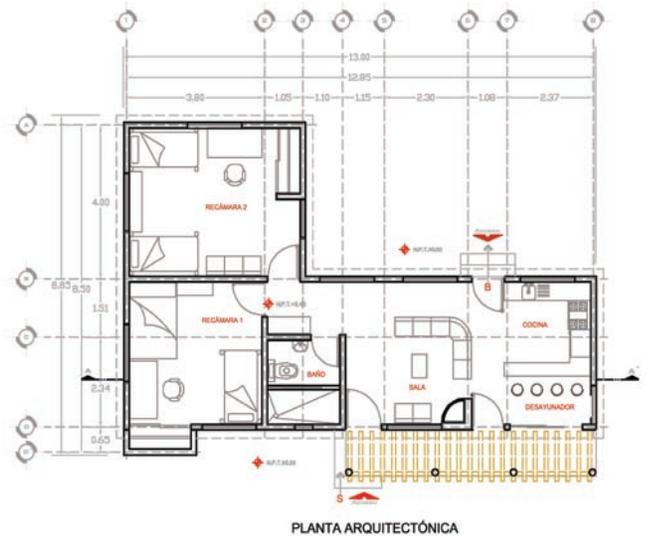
Zona Alta destinada al Descanso, 2 - 3.- Planta Arquitectónica y Fachada de Cabaña Tipo1.
